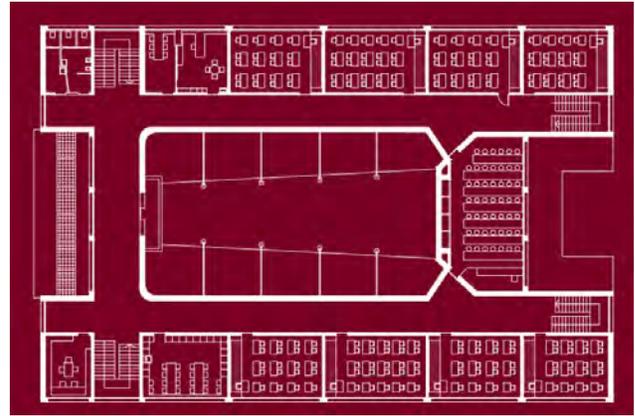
Planta Arquitectónica 1929. Fuente Carla Sentieri Omarrementeria. [15-05-2016]
